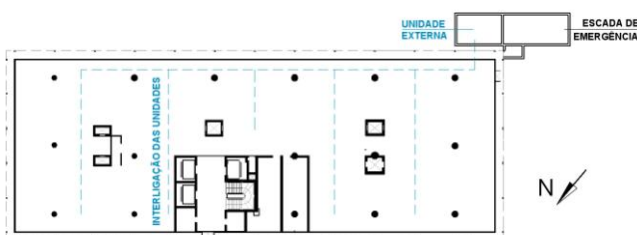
Planta baixa esquemático do Sistema de Ar Condicionado.
